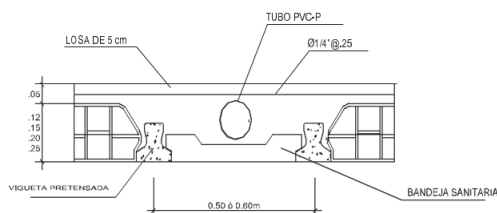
Detalle de instalaciones sanitarias paralelas a la viga.
